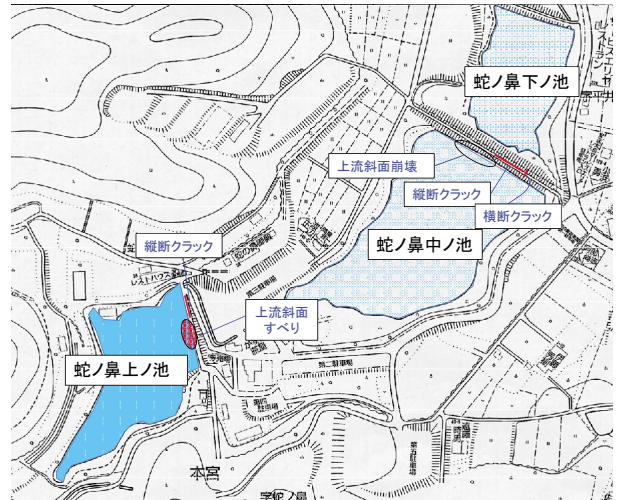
蛇の鼻上ノ池・中ノ池・下ノ池の平面図
